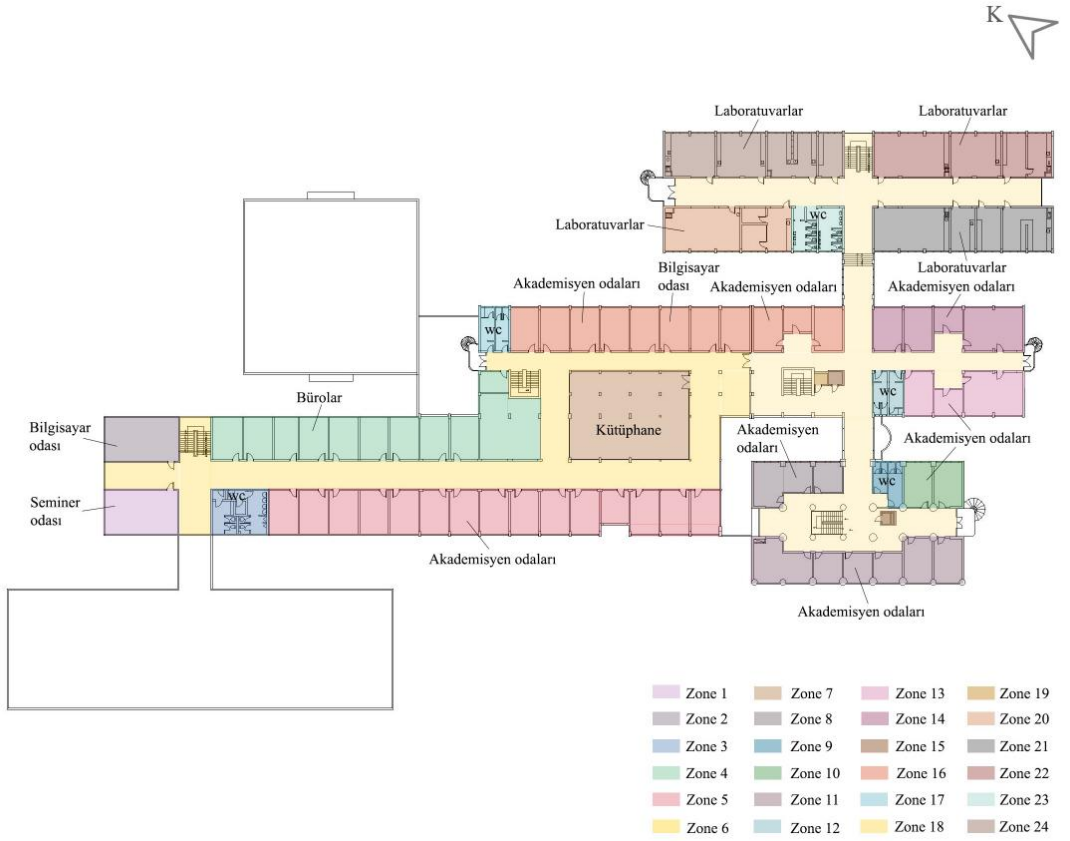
M.M.F binası 3. kat planı ve ısı bölgeleme.
